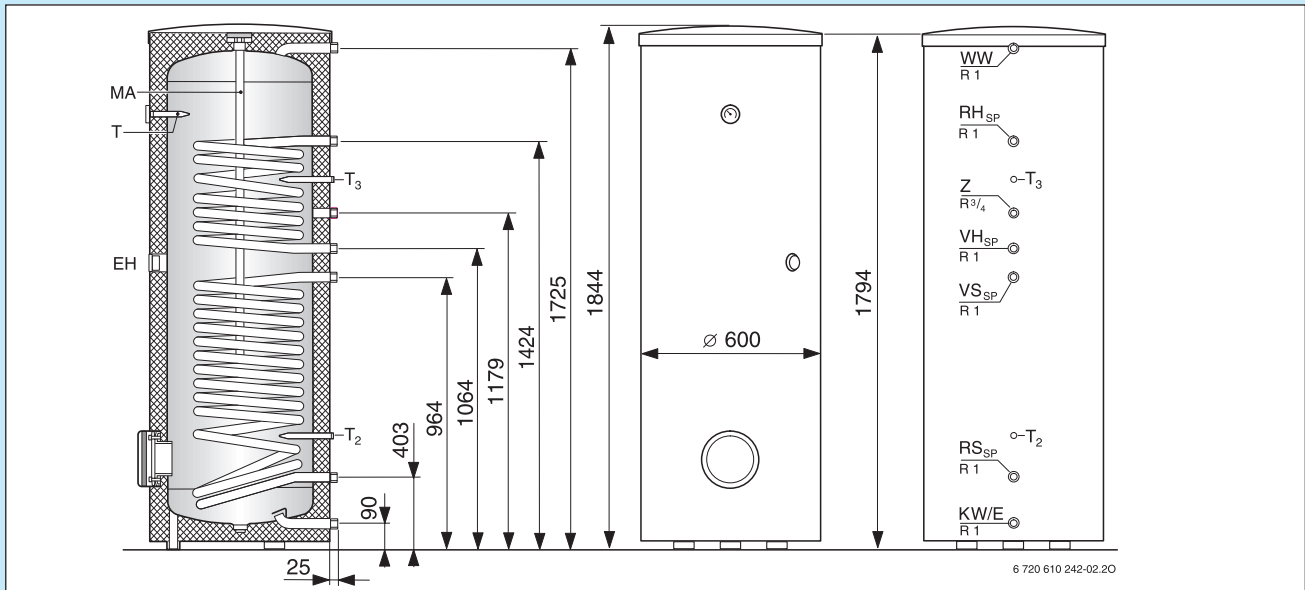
Bau - und Anschlussmaße SK 300-1 solar
